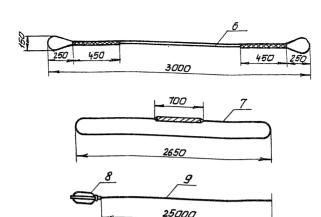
Детали строповки опоры 45 500-1 6- строп ф17,5 км 7- универсальный строп ф17,5 км 8- инвентарнае освобождающее устройство 9-канат капроновый ф9,6 км
